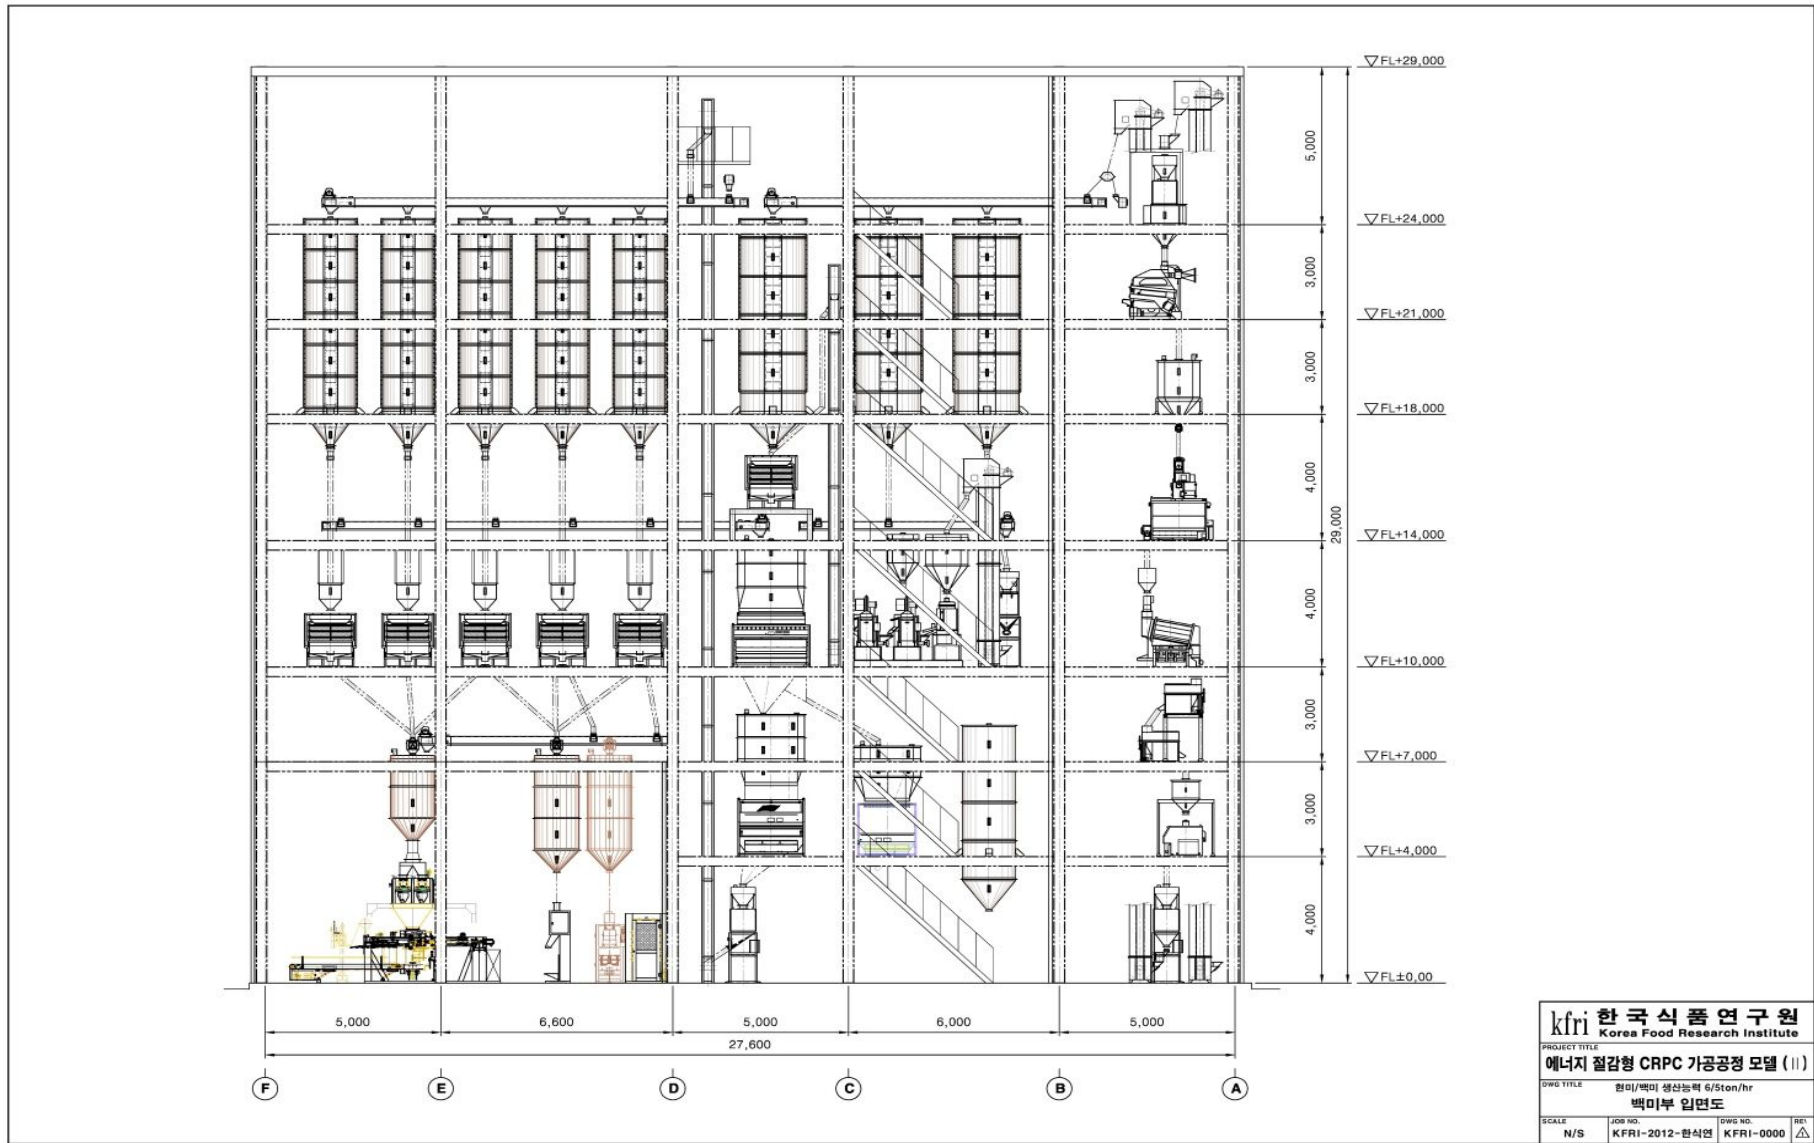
현미/백미생산능력 6/5ton/hr인 에너지절감형 가공공정 모델(II)의 백미부 입면도
